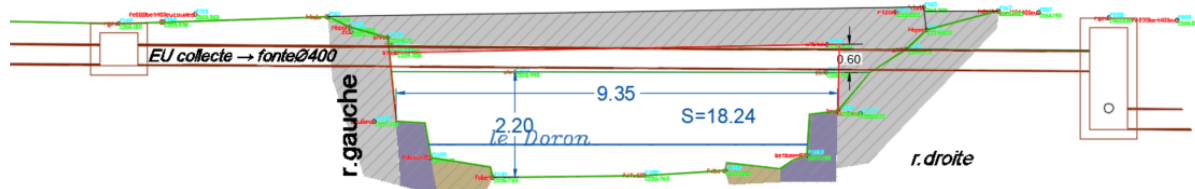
Ouvrage traversant n°4 – profil topographique (face aval)
